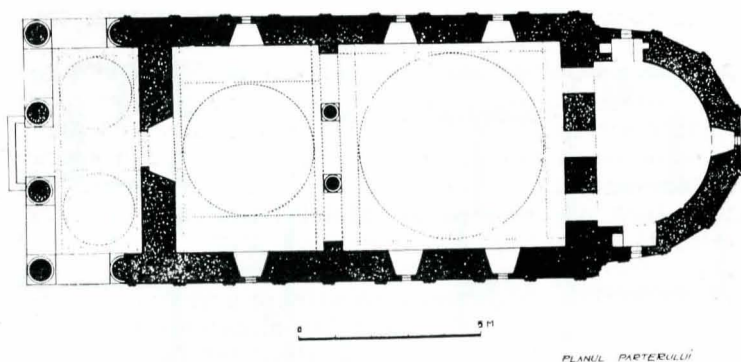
Biserica din Drugănești, proiectul de restaurare — plan.
